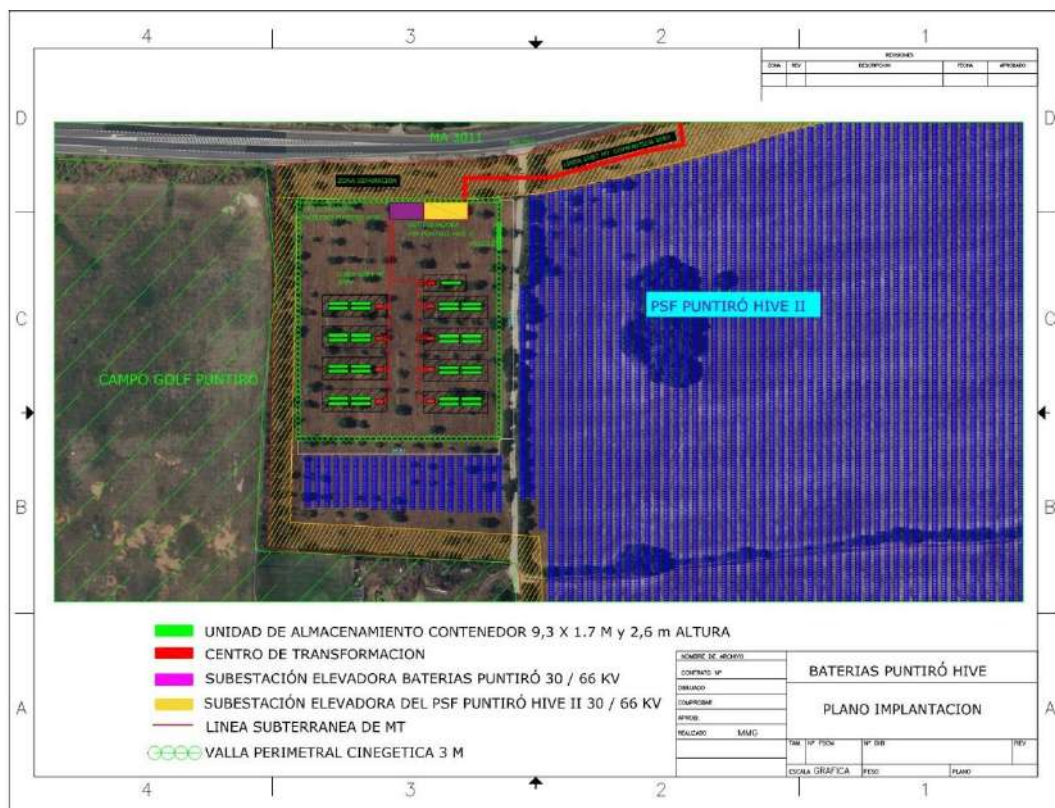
Planta general de las instalaciones. Fuente: PODARCIS, S.L
